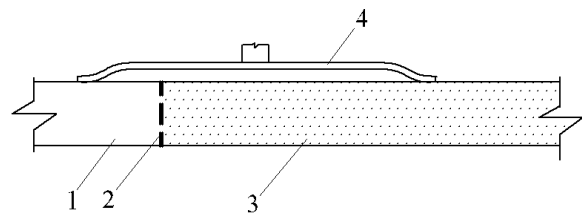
Уплотнение бетонной смеси в месте устройства рабочего шва плиты перекрытия с помощью вакуумирования.
